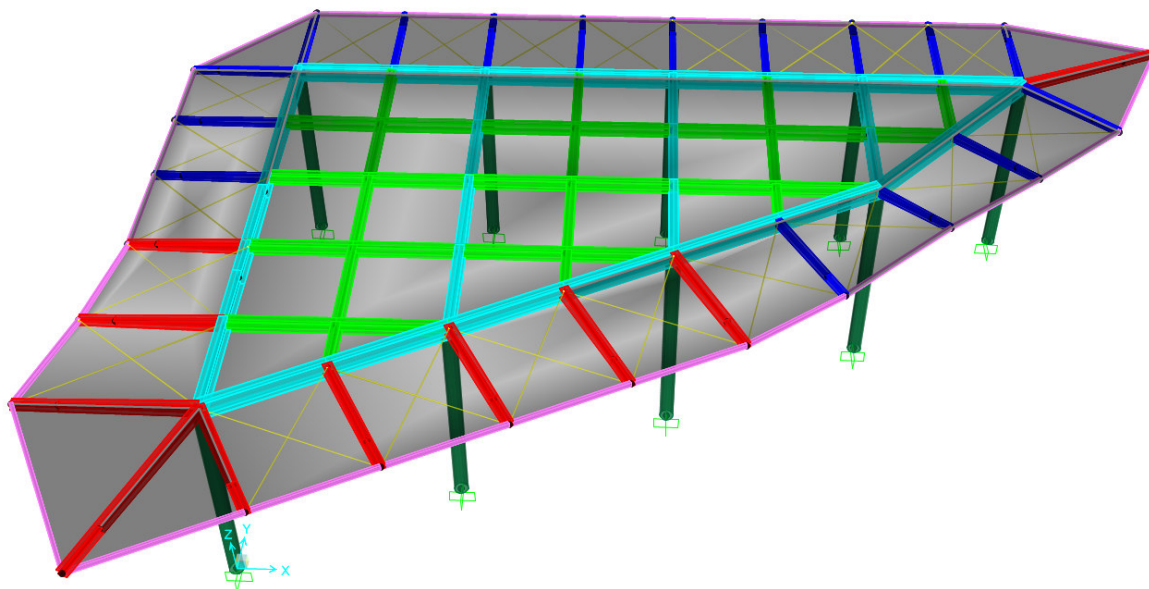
Modello SAP2000 struttura – Vista estrusa.
